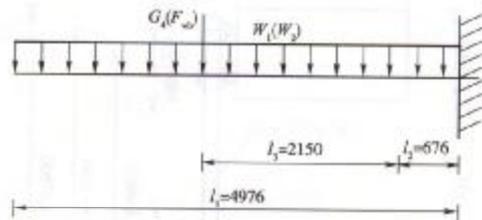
横梁受力图(尺寸单位:mm)
